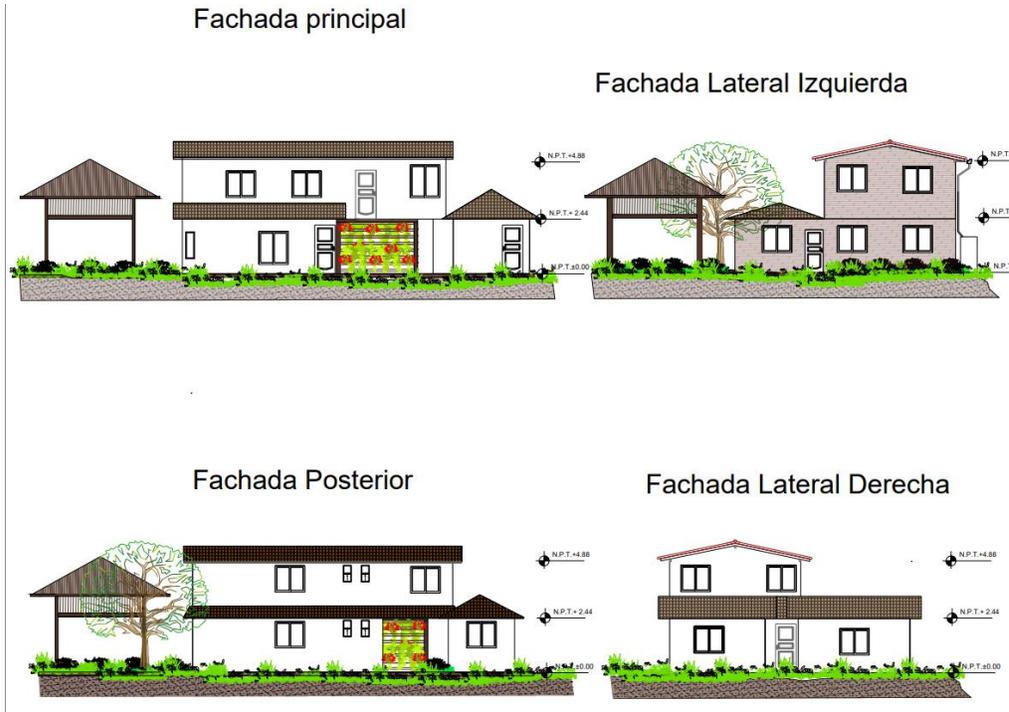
Ilustración 56 Fachadas Tipología de vivienda II
